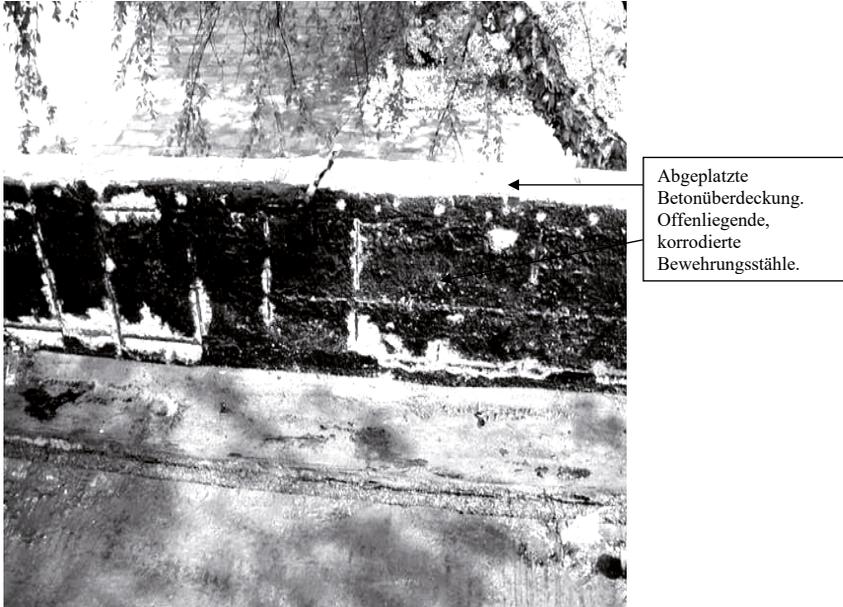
Der nach dem Abriss der Abdichtung sichtbare Untergrund weist deutliche Schäden, Abplatzungen und Korrosionsschäden auf und ist nicht mehr ausreichend haftfähig. Vor der erneuten Abdichtung muss eine Betoninstandsetzung erfolgen.
